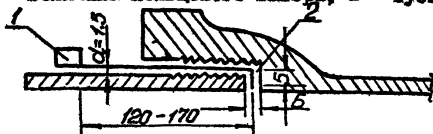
Проволочный крючок для замера величины зазора между торцами стыкуемых труб
